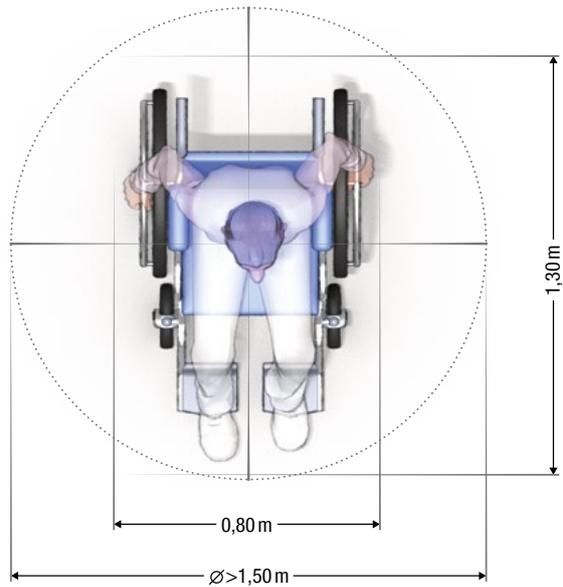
Gabarit d'une personne se déplaçant de façon autonome en fauteuil roulant.
